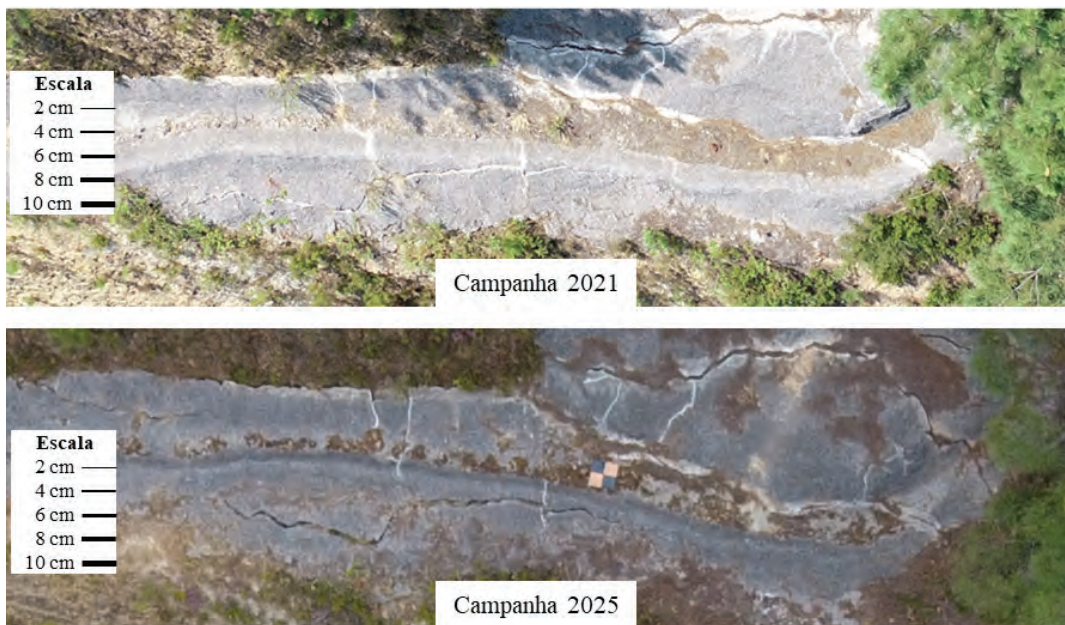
Fissuras na calceira do talude de escavação junto ao descarregador.
